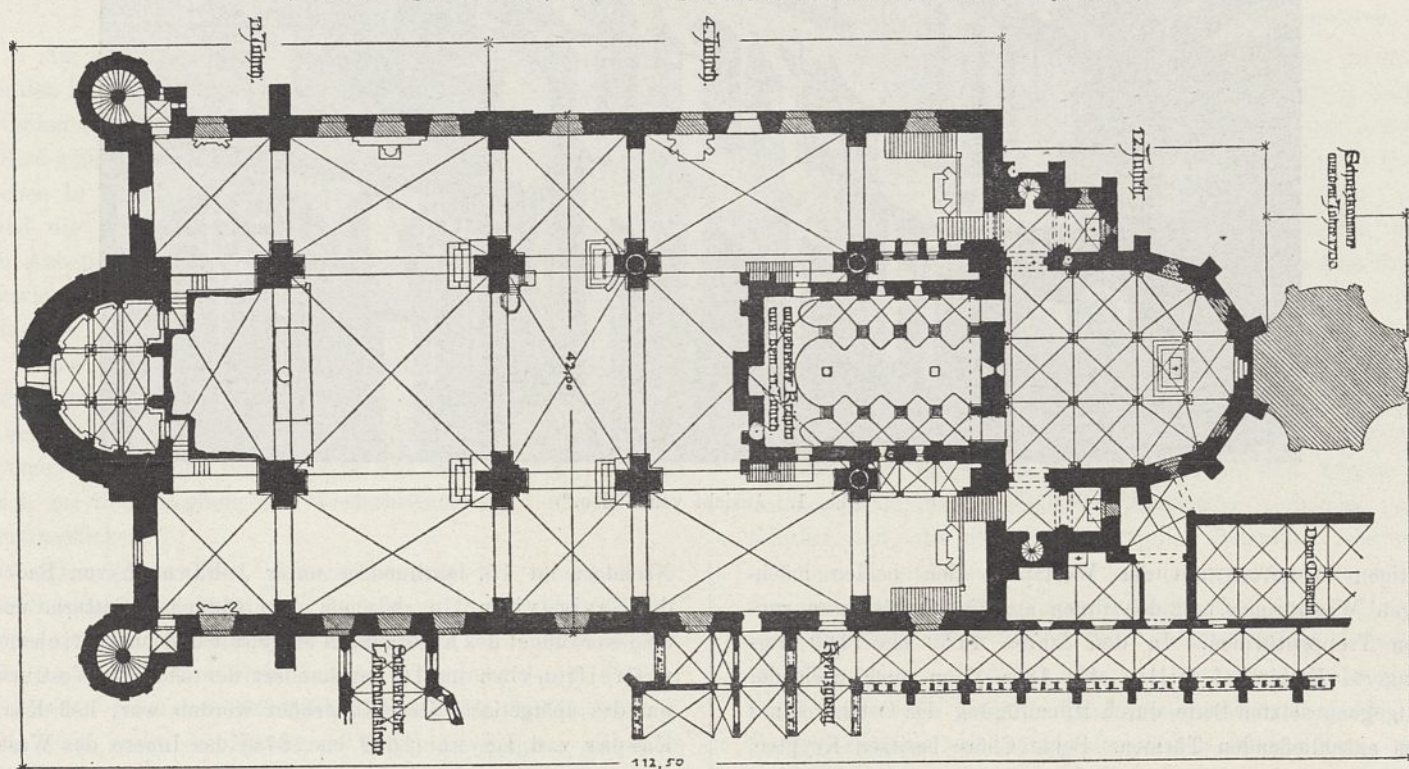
Grundriß zu ebener Erde mit durchschnittenen Krypten.
